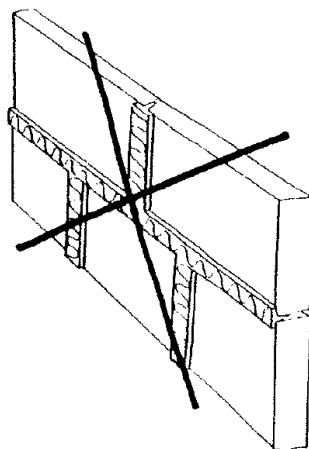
Erro de aplicação da cola entre as placas de isolamento térmico
